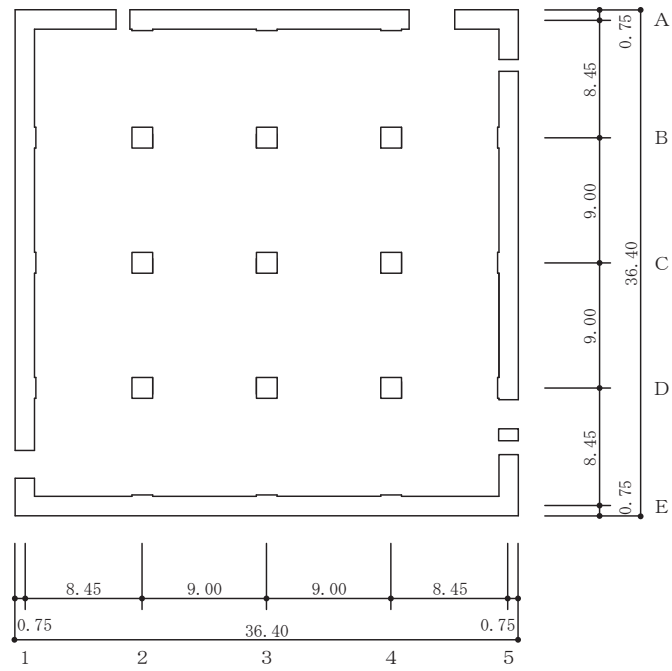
(1) 緊急時対策建屋の概略平面図 (O.P. \*51.5m)
